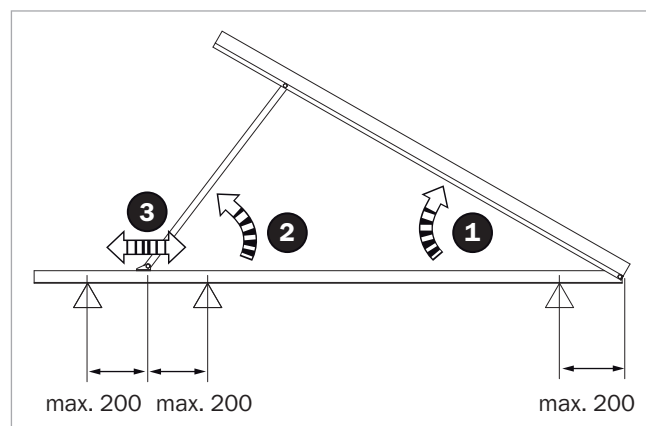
Estructura del soporte para tejado plano 1 2 3
